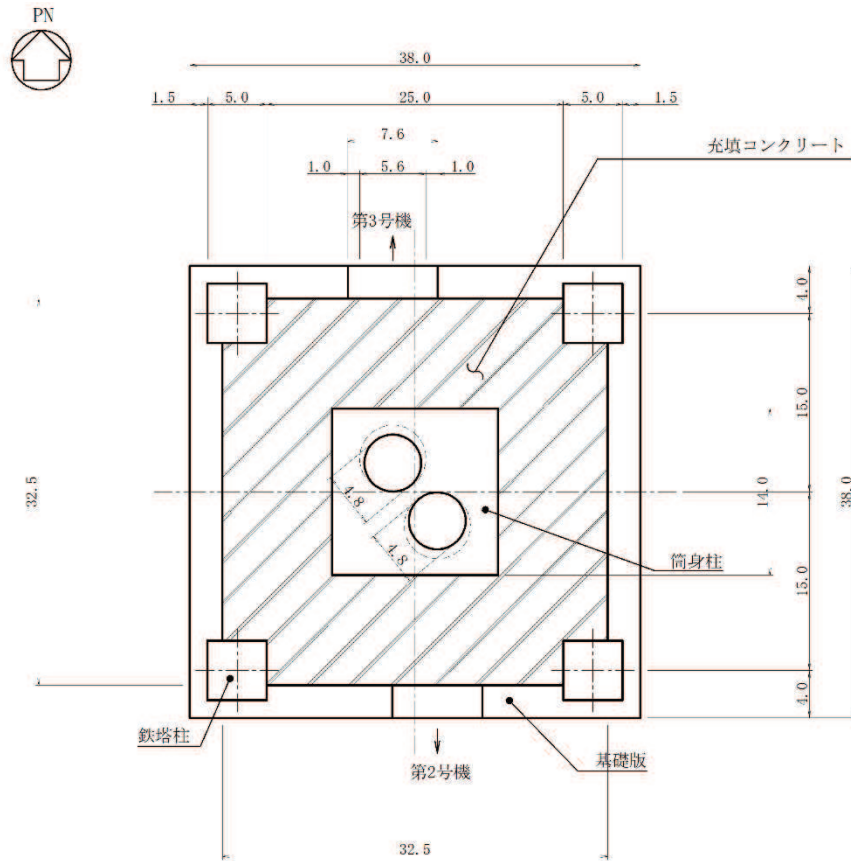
排気筒基礎平面図 (O.P. 8.505m)
